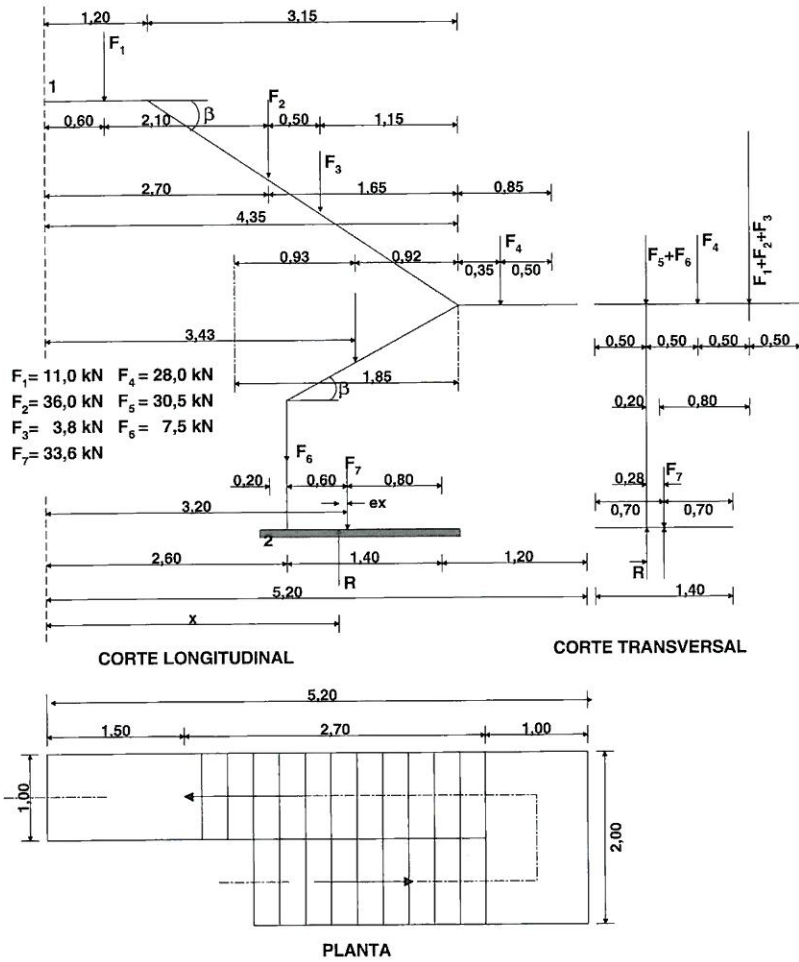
Esquema dos cortes longitudinal e transversal e planta de uma escada de dois lanços em consola
